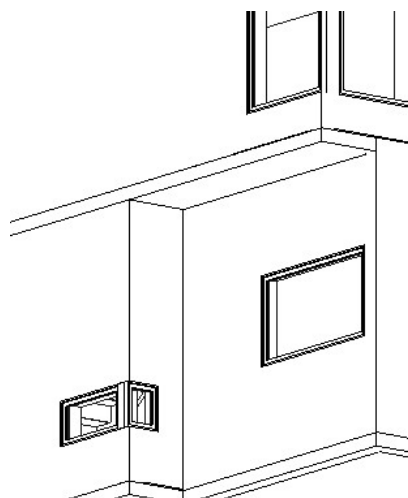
Vigas em balanço devido janela de canto do 2º pavimento
